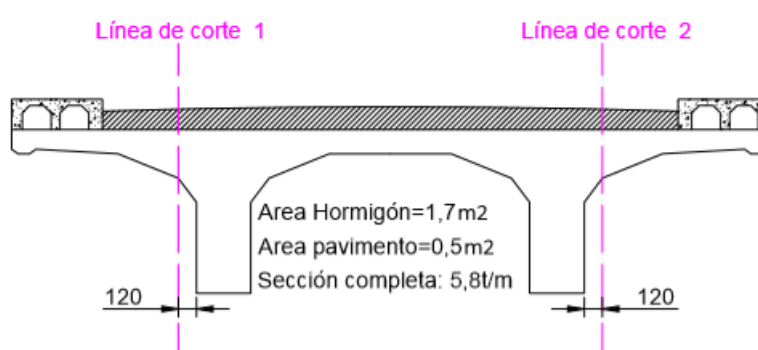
Primera propuesta de líneas de cortes para losa de punzonamiento AutoCAD.
